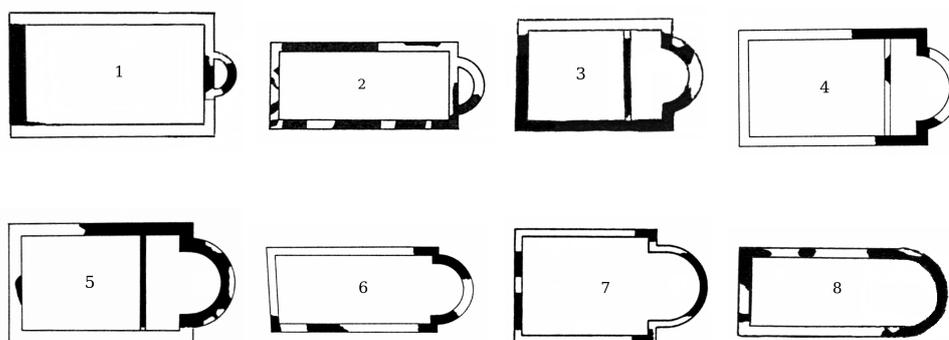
Grundrisse von Steinkirchen mit Apsis (nicht maßstabsgerecht).
